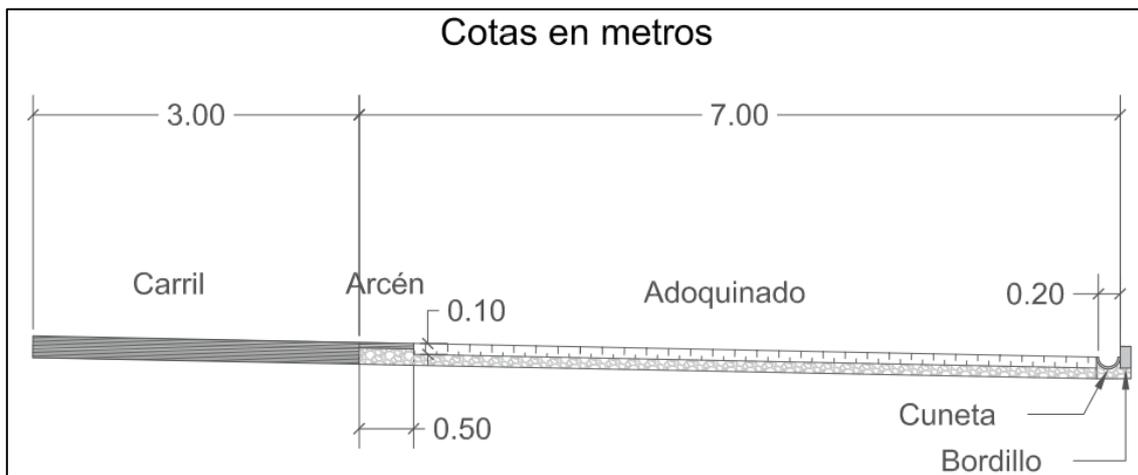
Sección de zona de estacionamiento adoquinada.
